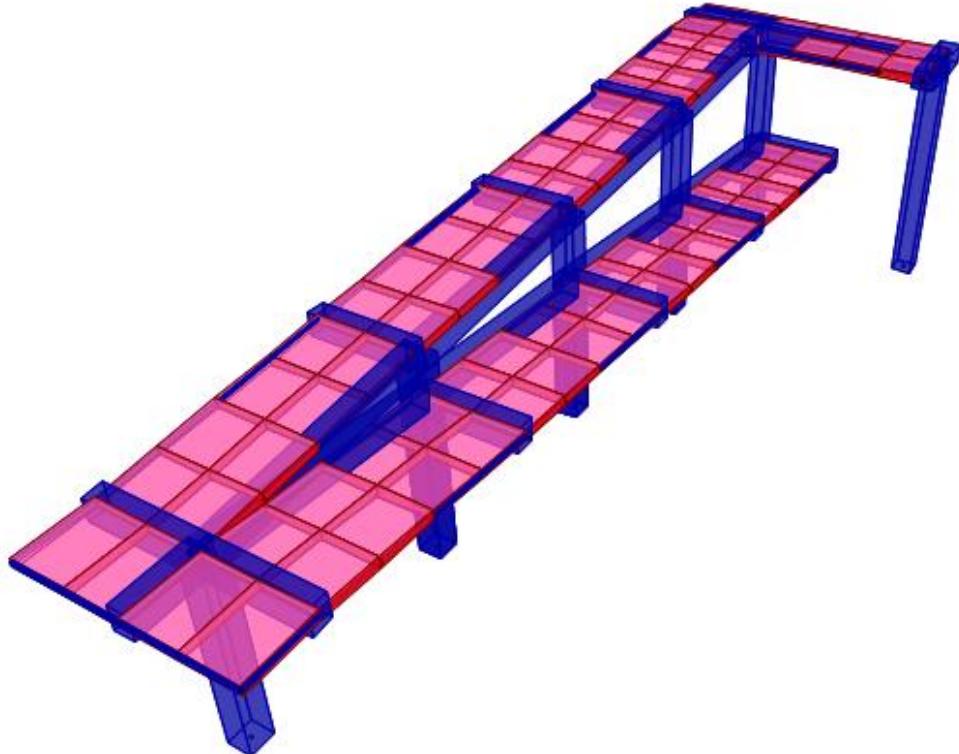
VISTA ESTRUCTURA RAMPA.
